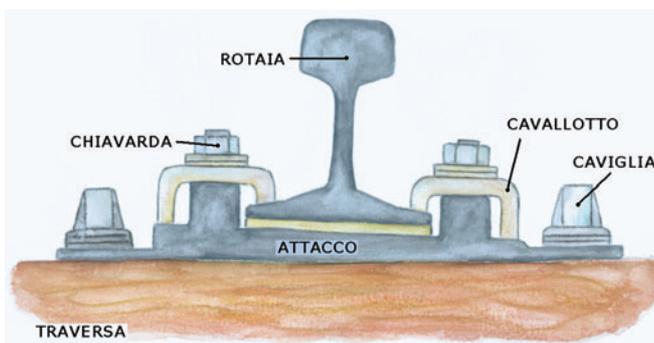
Armamento. Sezione illustrante i componenti dell'armamento ferroviario.
